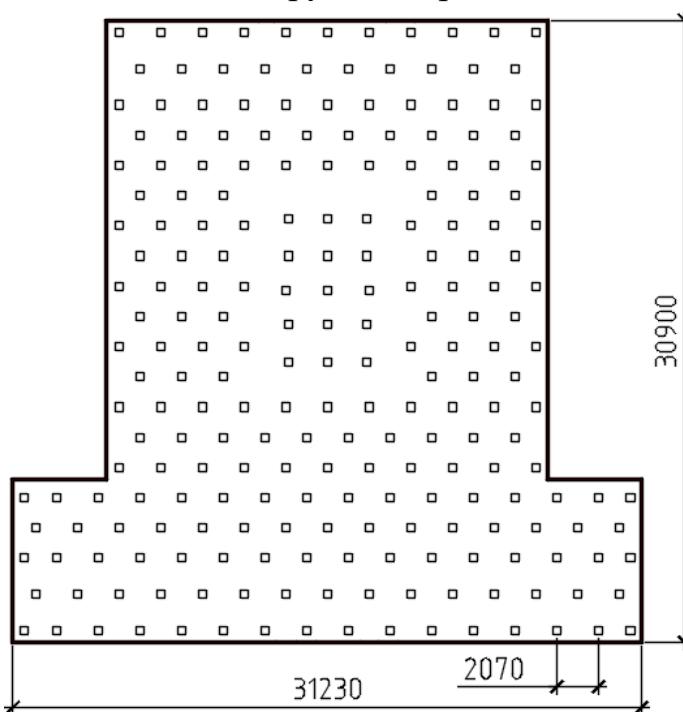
Опалубочный чертеж монолитной плиты фундамента
